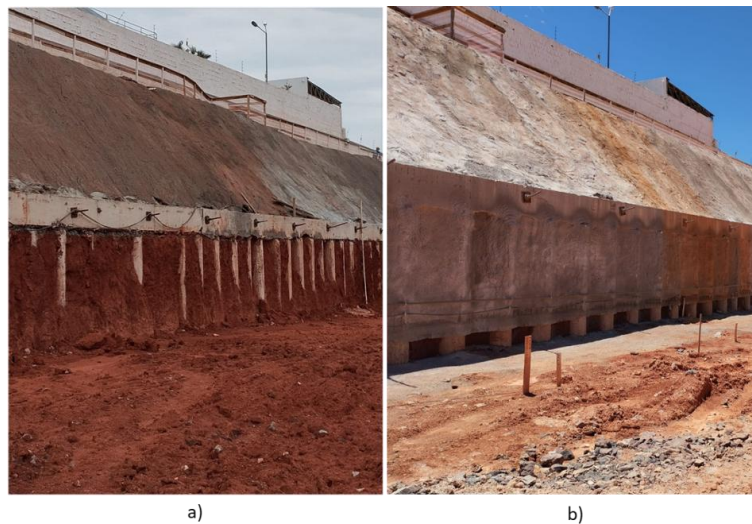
Imagens em perfil do sistema de escavação: a) recém escavada; b) com proteção da cortina.
